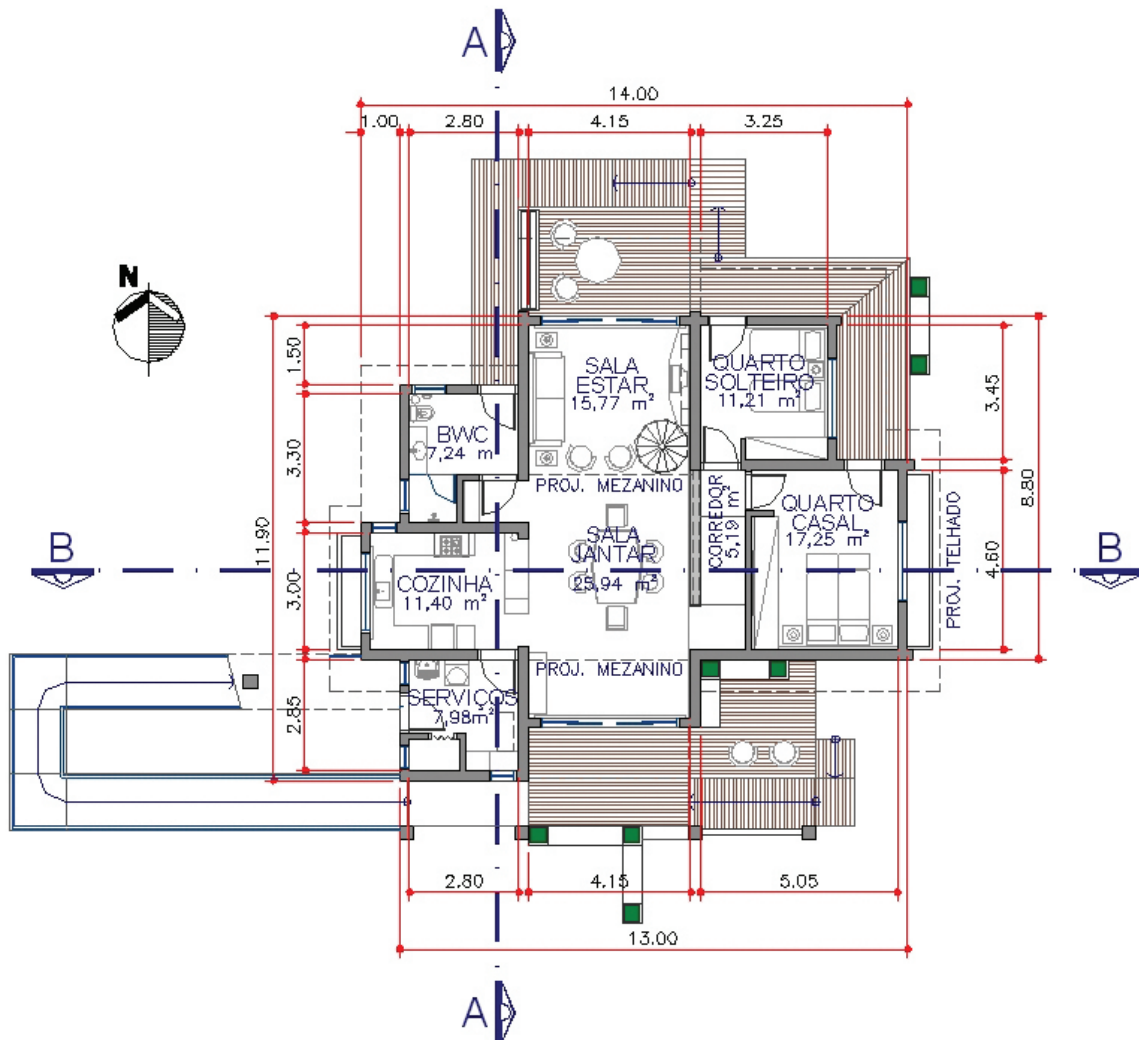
Planta baixa da Casa Eficiente – pavimento térreo.
